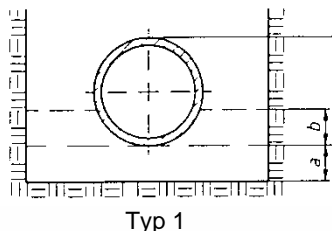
Rohrbettungen nach DIN EN 1610, Ziffer 7.2
